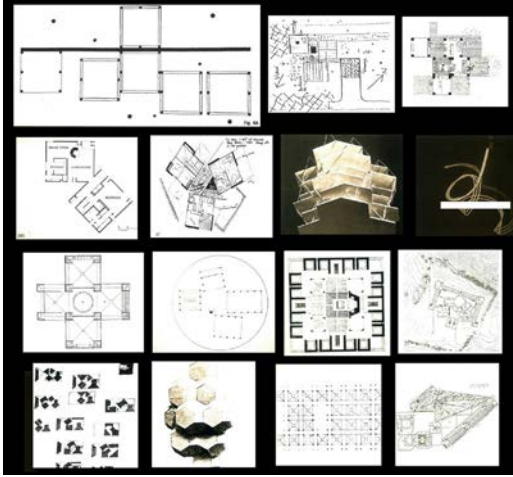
Baraja de plantas de la obra arquitectónica de Louis Kahn
